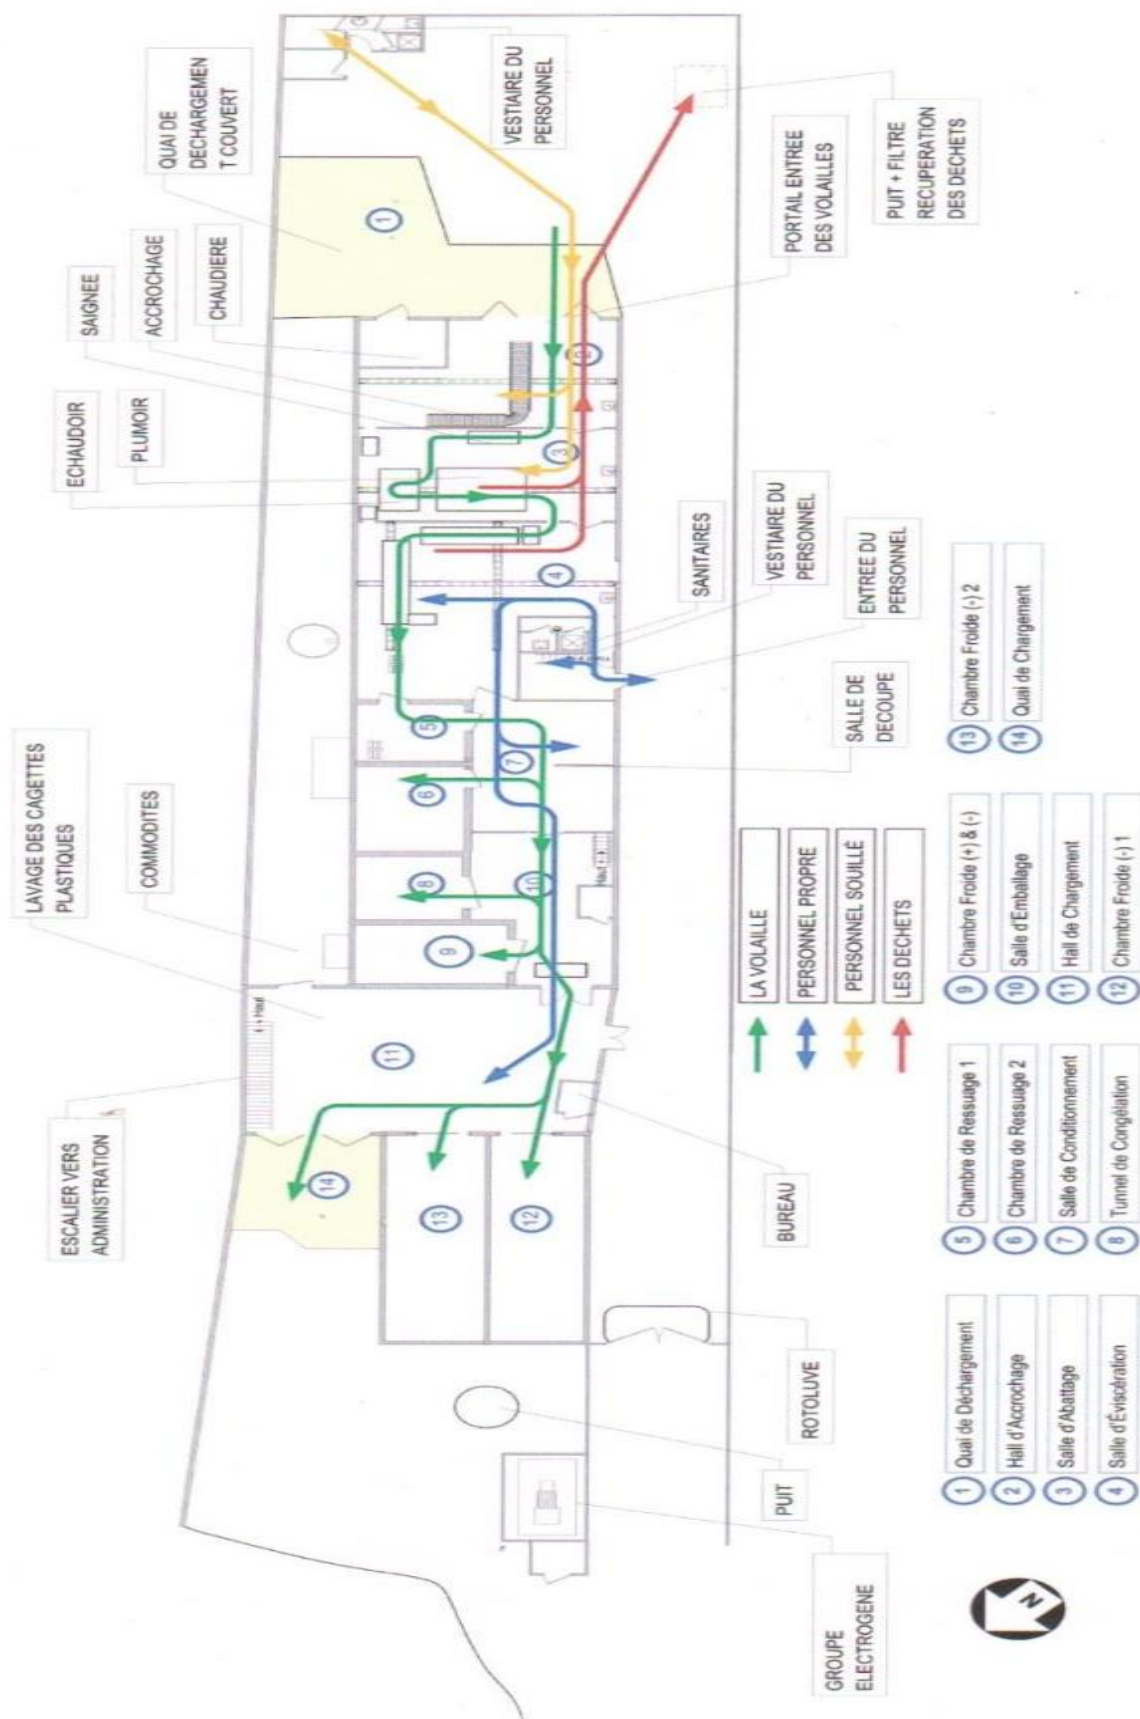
Plan de masse de l'abattoir avicole AIN SAR
